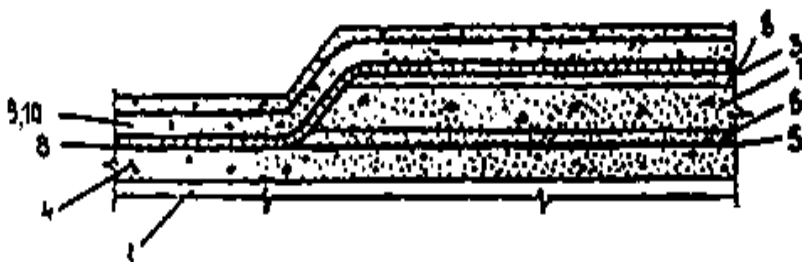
Конструкция гидроизоляции перекрытия тоннелей:
